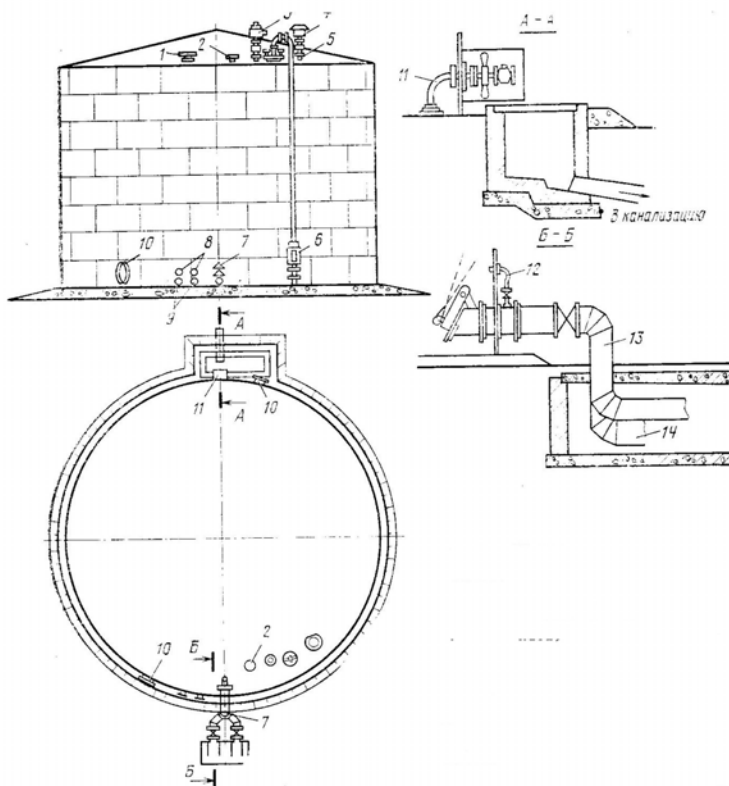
Металічний (зварний) наземний резервуар для зберігання дизельного палива:
